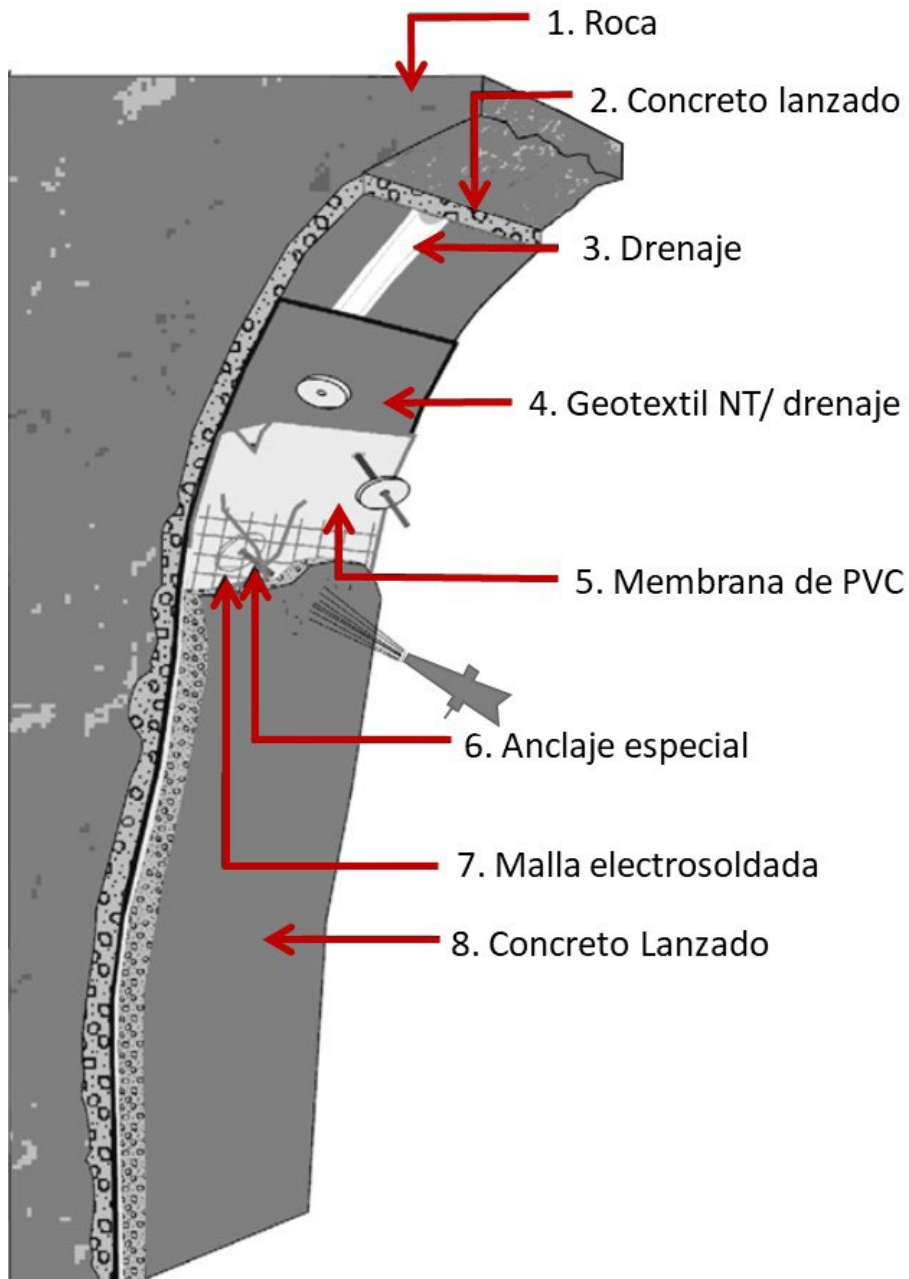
Impermeabilización con membrana de PVC + Geotextil adherido y anclajes
